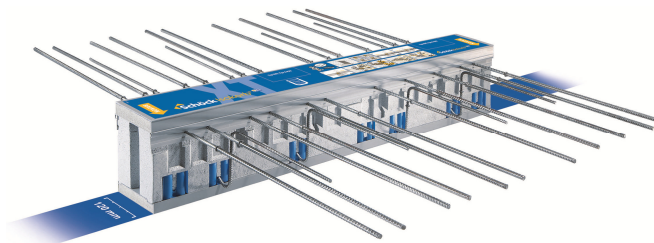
Połączenie drewno-żelbet z SCHÖCK ISOKORB®
